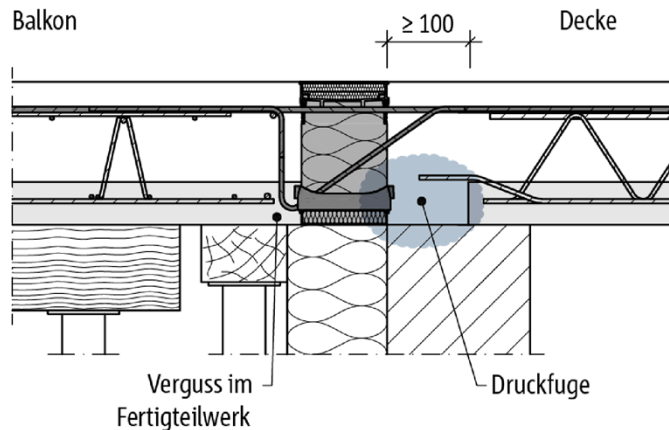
Schöck Isokorb® Typ K mit CCE oder SCE und Elementplatten, Druckfuge
